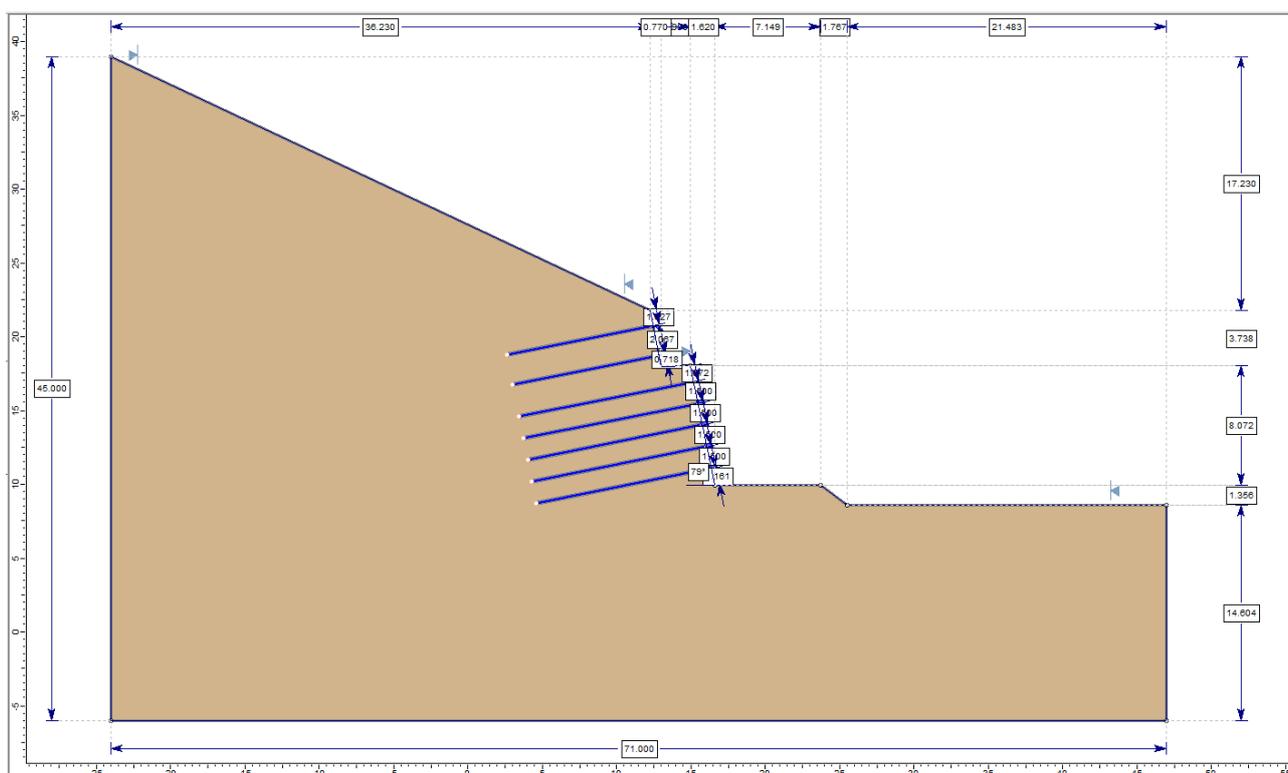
Prospetto delle pareti chiodate a tergo del muro di monte inferiore per la sezione A
